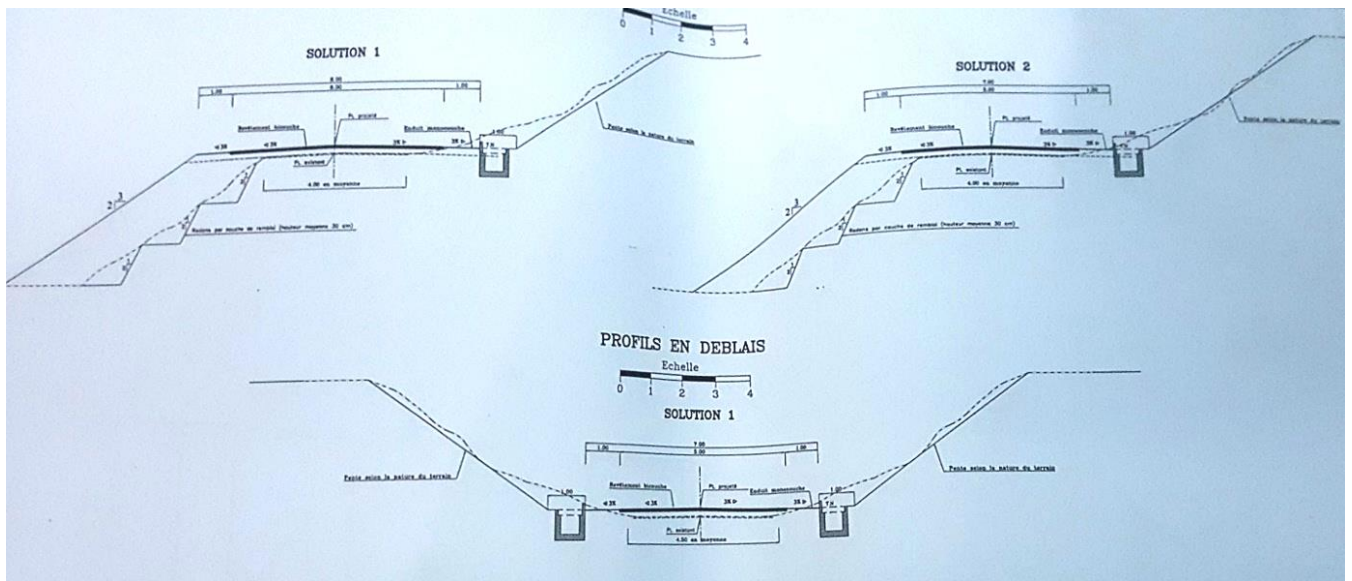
TROIS SOLUTIONS PROPOSEES POUR LE PLAN TYPE PROFIL MIXTE ET PROFIL EN DEBLAI
